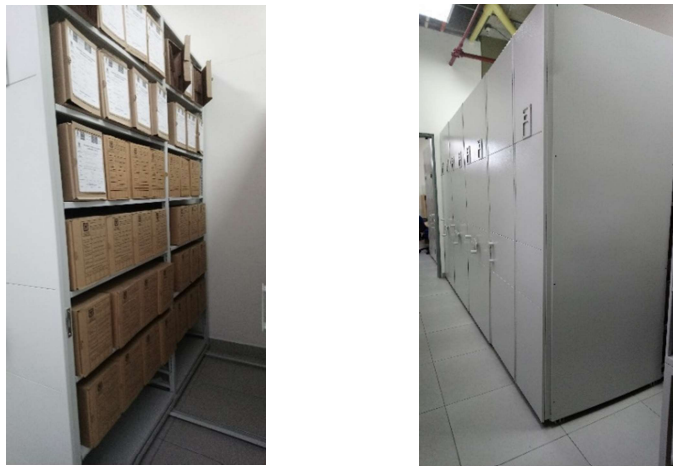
Tubería descubierta en el techo sobre la estantería
